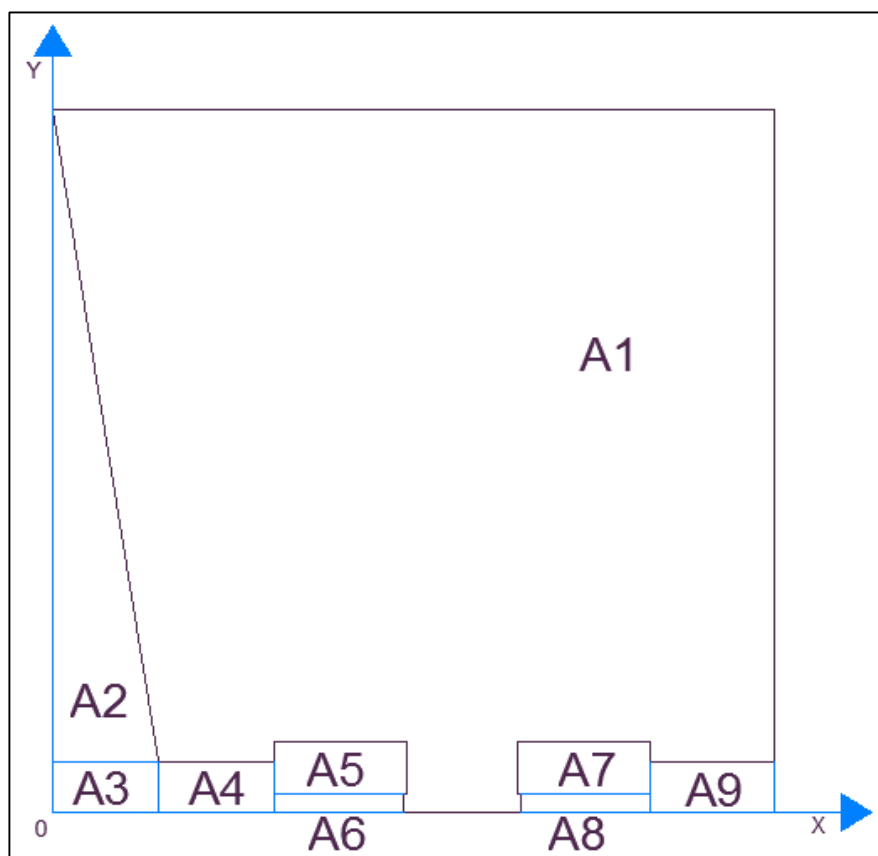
Áreas en planta para el cálculo de excentricidad.
